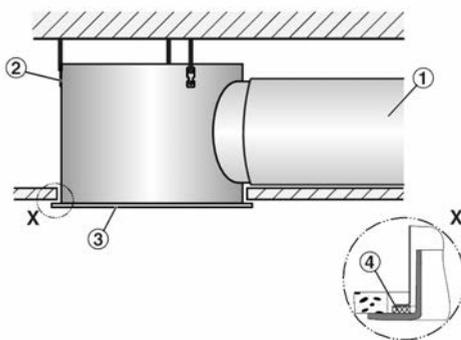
Montage à ras du plafond avec caisson de raccordement circulaire
